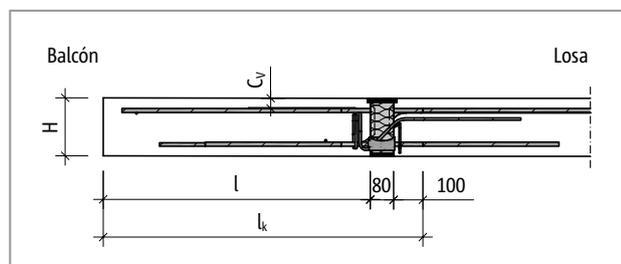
Schöck Isokorb® T tipo C: Sistema estático
